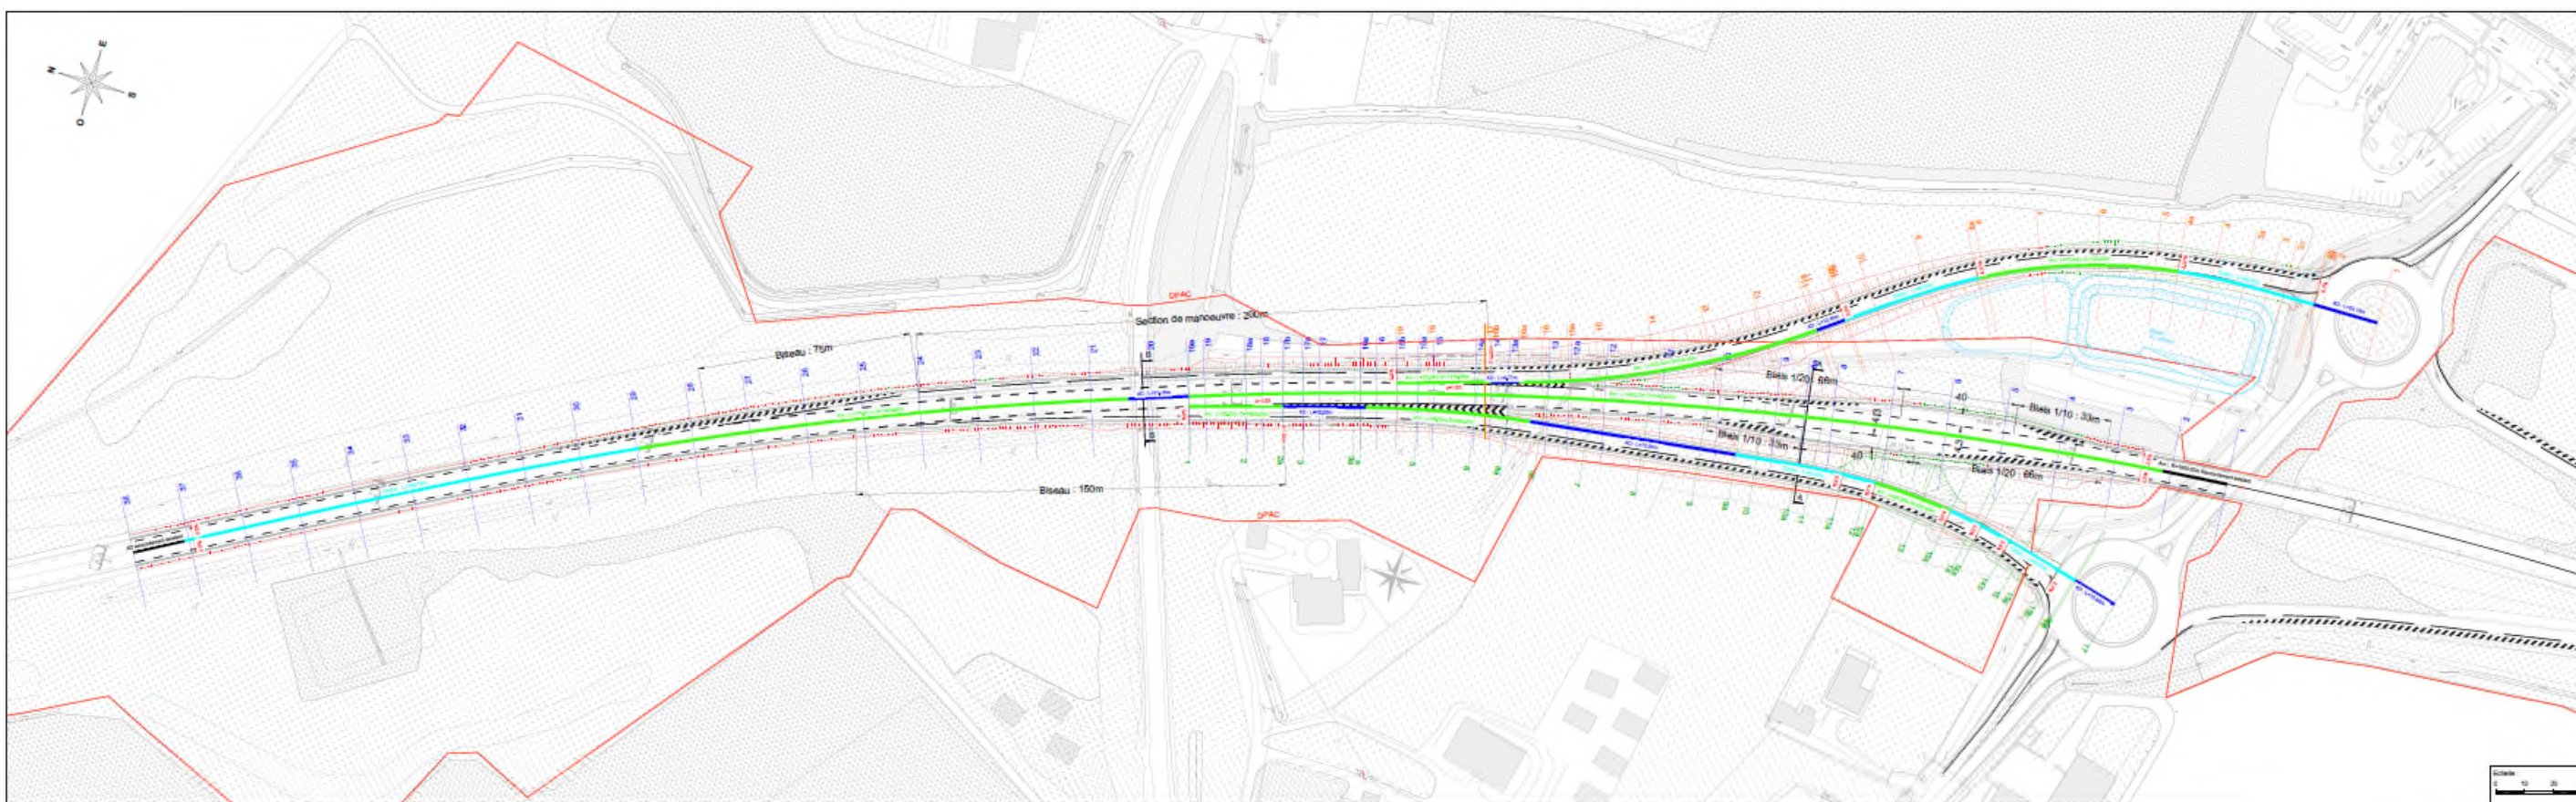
Vue en plan du projet (Source AVP – Verdi)
